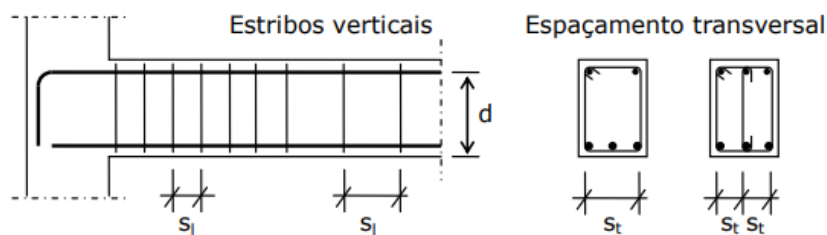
Espaçamento longitudinal e transversal de armaduras de esforço transversal [4].
